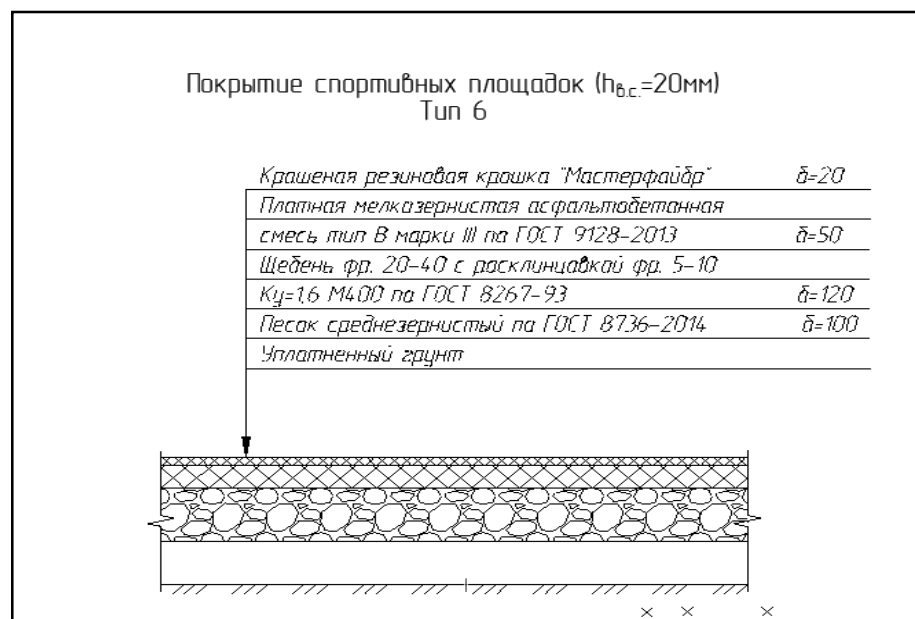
Устройство покрытия спортивных площадок. Тип 6
